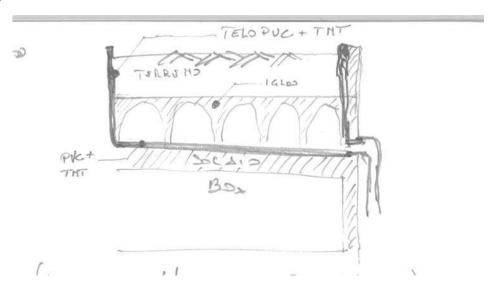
Posizione dello strato impermeabile nel pacchetto di "copertura"
